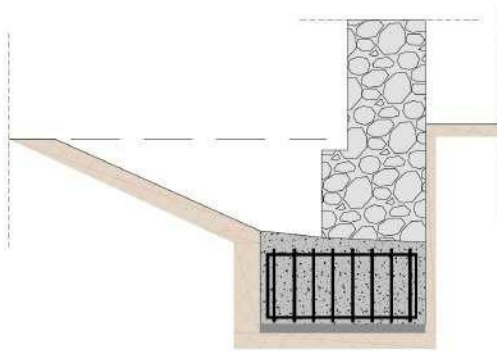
Sección zapata corrida. Refuerzo Tipo 4. Fuente propia
